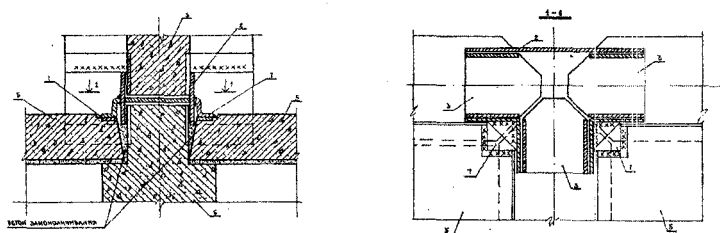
Узел сопряжения рамок каркаса и панелей перекрытия
